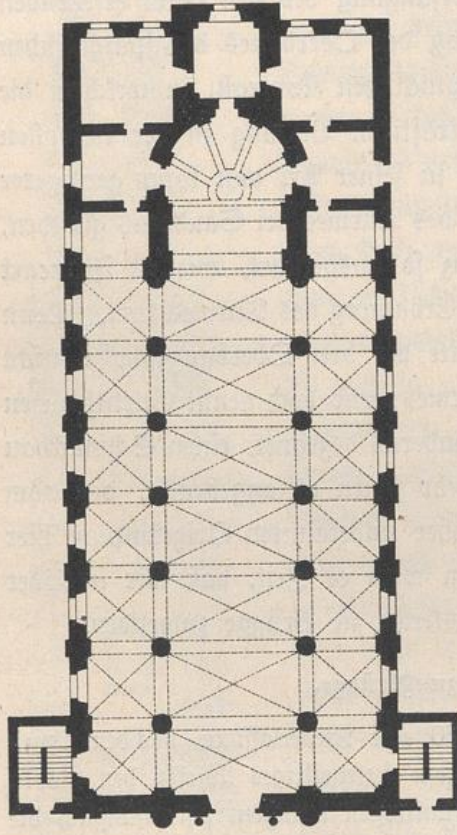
Brügge. Frühere Jesuitenkirche. Grundriß.
